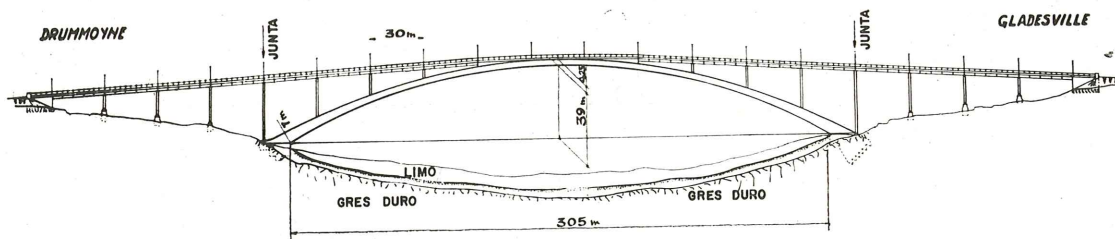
El puente de Gladesville. Dimensiones principales.
